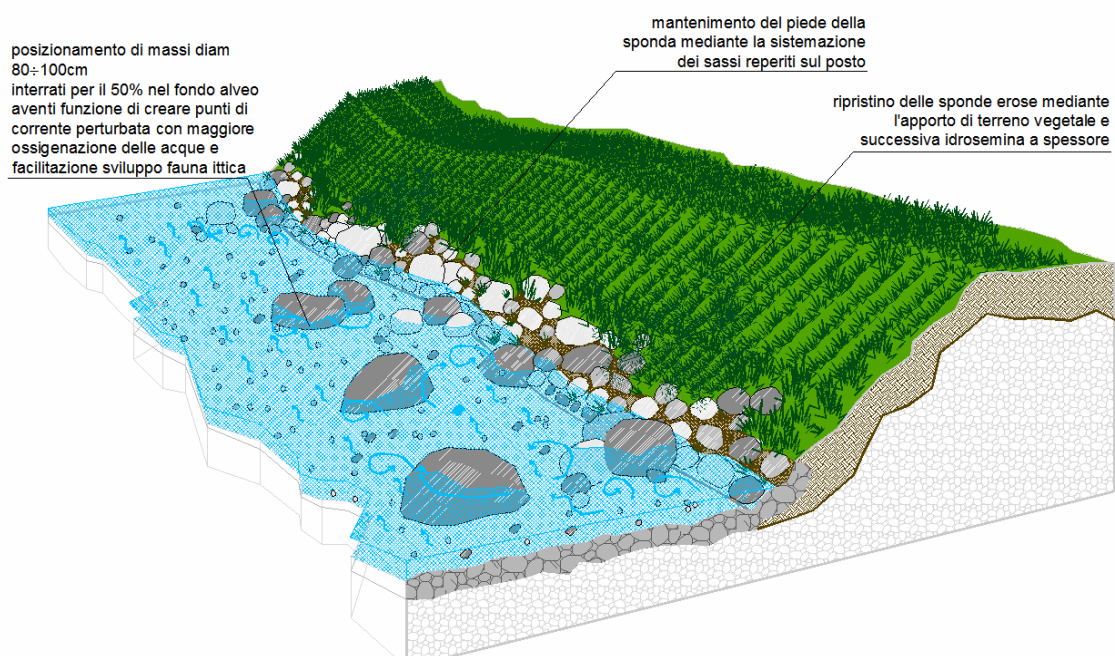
intervento di progetto della protezione spondale in sassi lungo i tratti maggiormente esposti alle erosioni.
